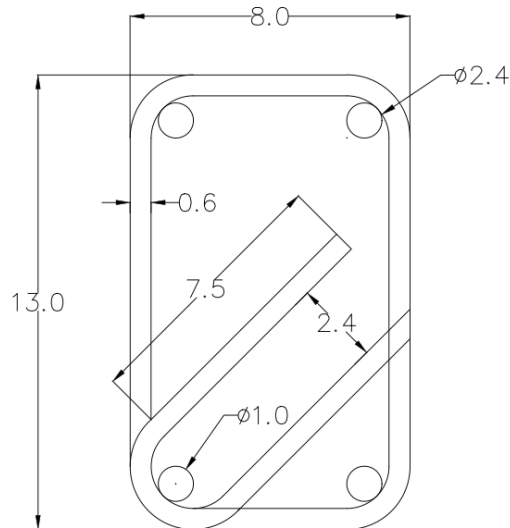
Detalle del estribo cerrado de confinamiento.
